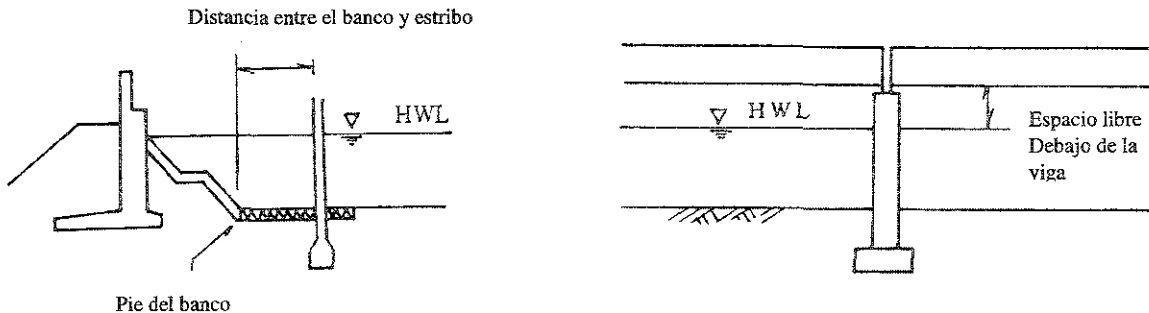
Luz mínima entre pilares y entre pilar y estribo
